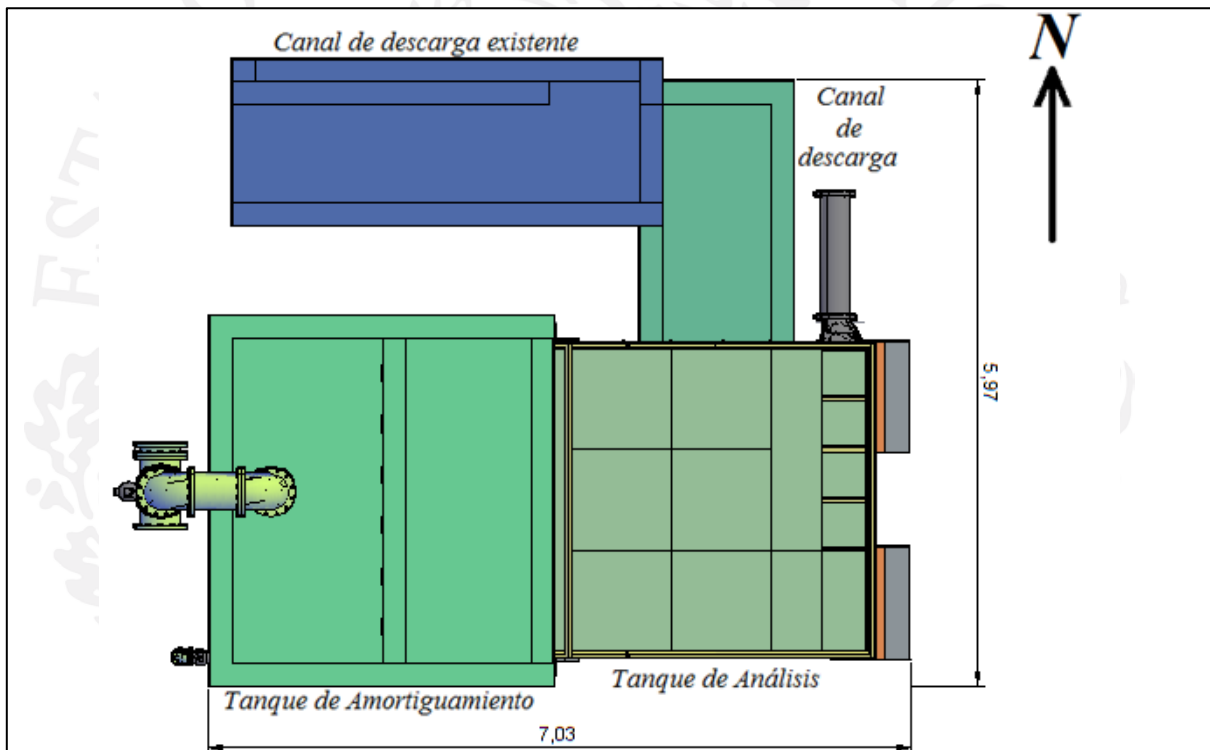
Dispositivo de ensaye (Vista en Planta)
